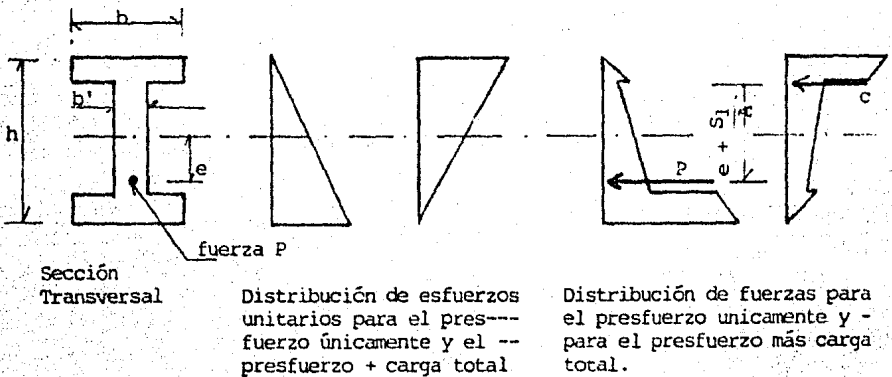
Distribución de esfuerzos unitarios y fuerzas en una viga de sección I, bajo el presfuerzo únicamente y presfuerzo más carga total.
